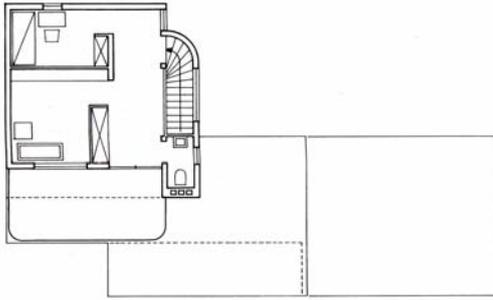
Weißenhofsiedlung Haus Adolf Radnig, Grundriss Obergeschoß
